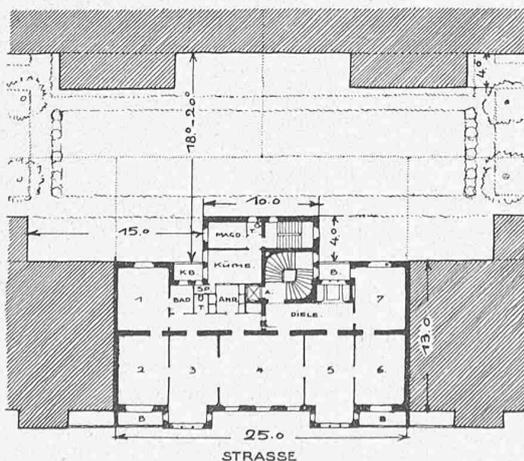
Grundriss-Typ, 1:600 (in Abb. 7 kreuzweise schraffiert).
